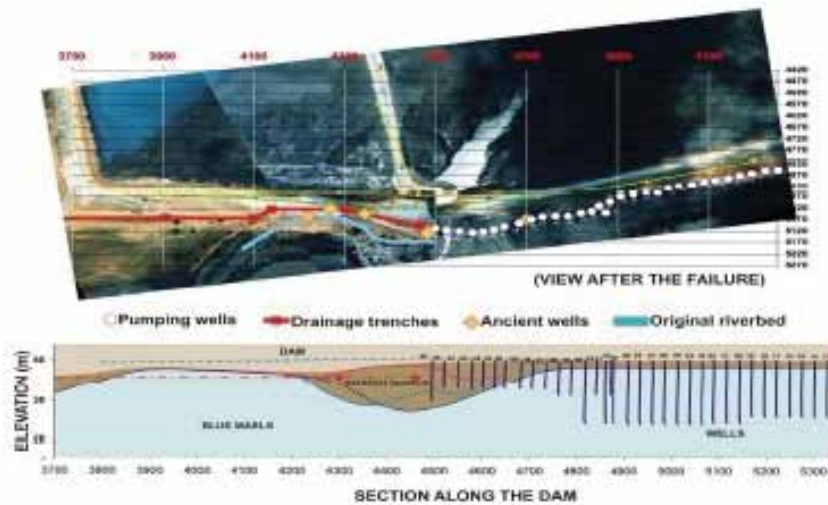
Sistema de drenaje presa de Aznalcóllar
